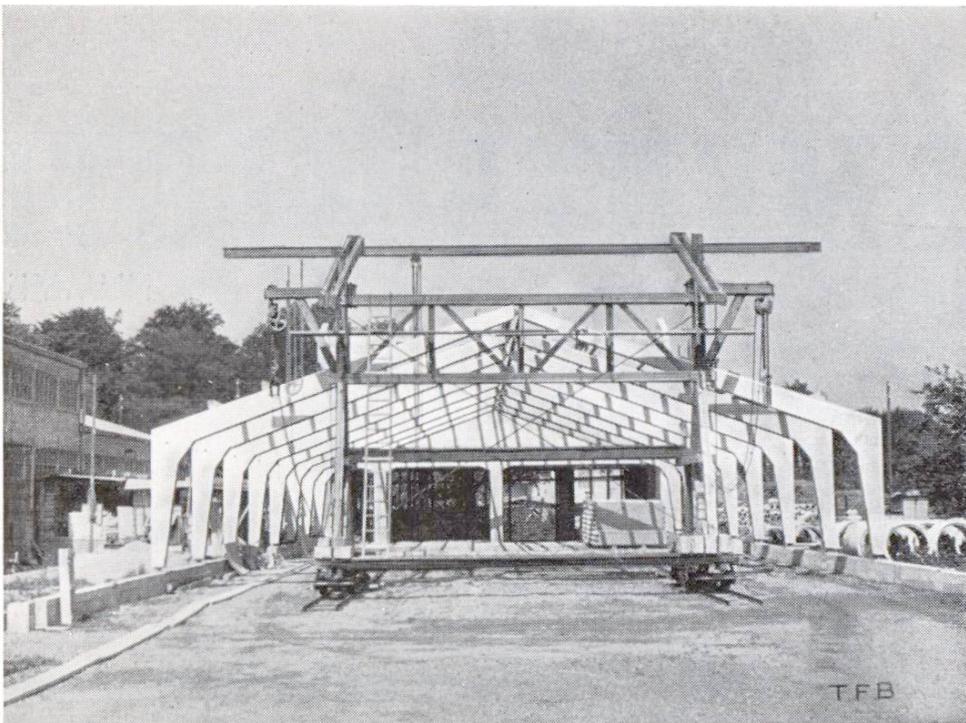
Montage der Eisenbetonbinder. Im Vordergrund Montagekran
